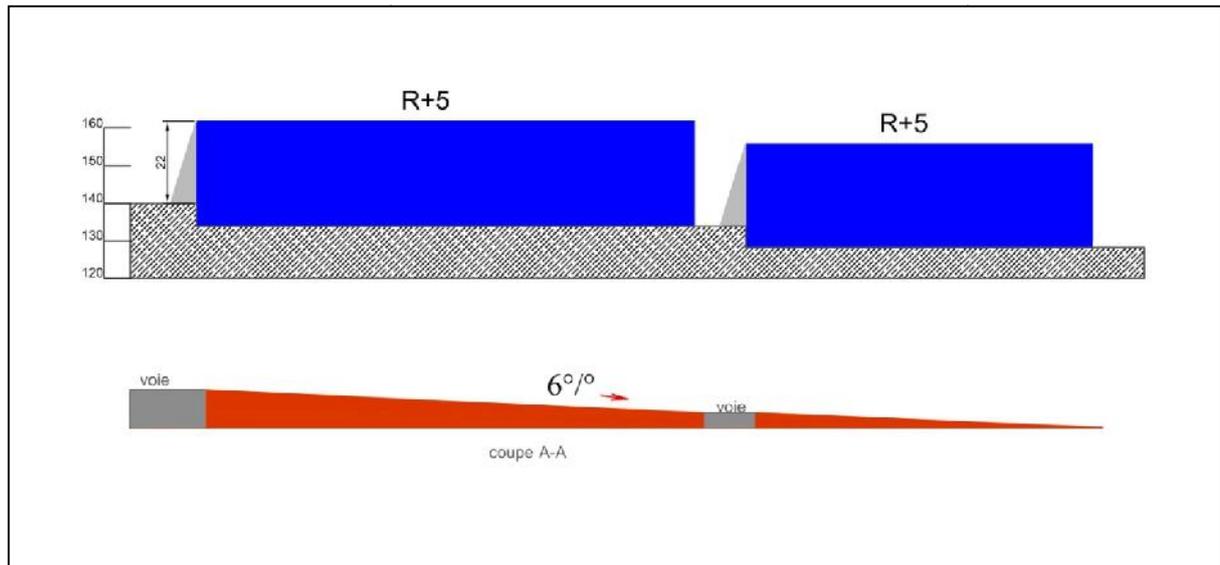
Coupe AA du site d'intervention, faite par auteurs.
